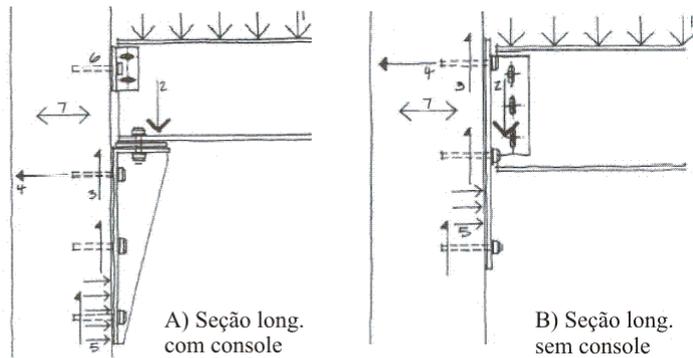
Carregamento em interface viga de aço - pilar de concreto com e sem console metálico.
